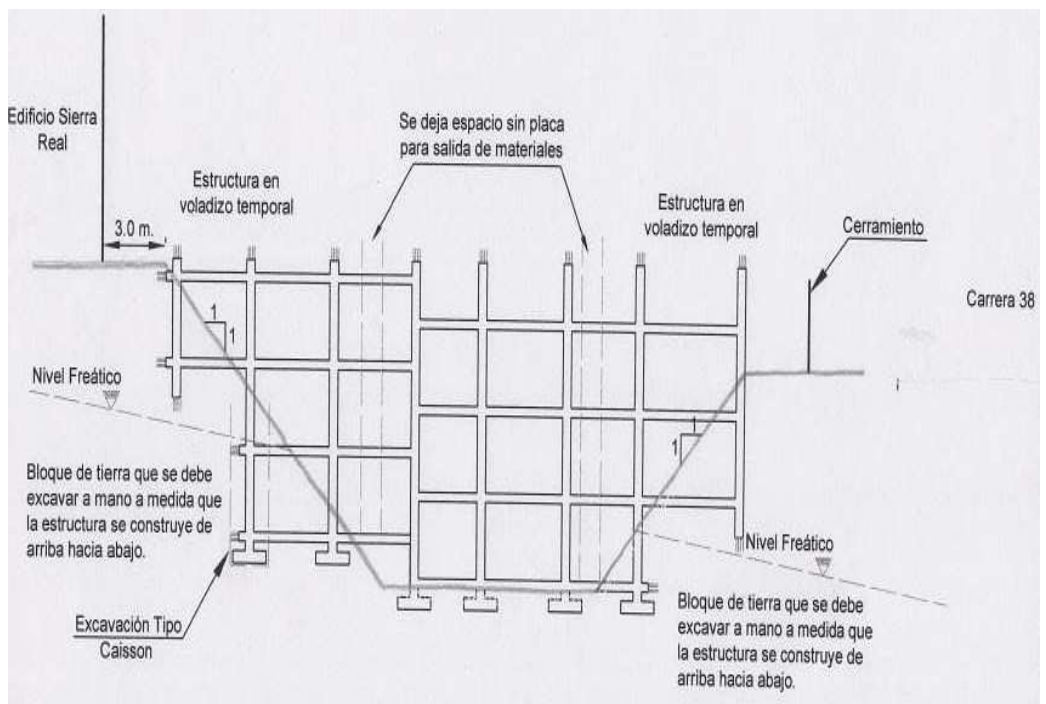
Diagrama 5 Construcción cimentación, Estudio geotécnico de suelo.
